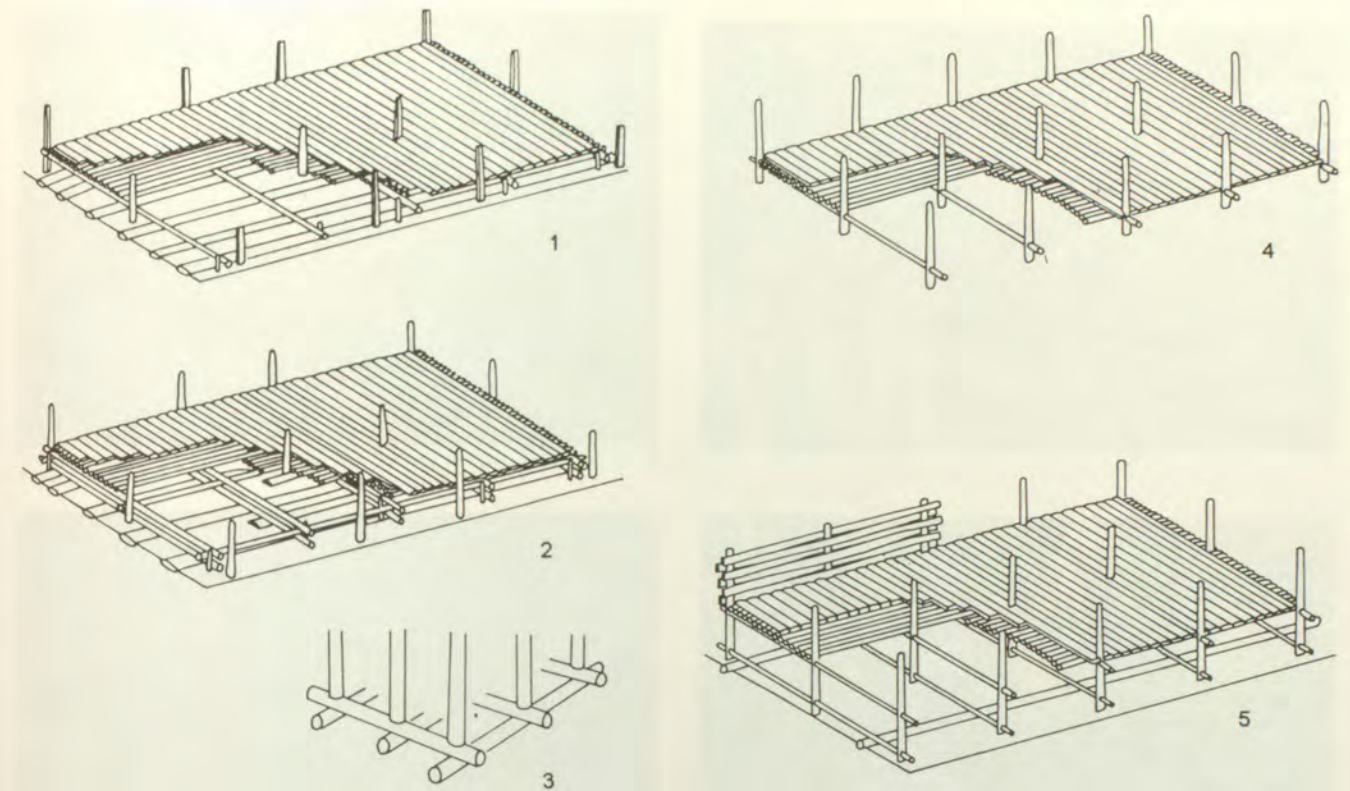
Bodenkonstruktionen in Thayngen-Weier [70]. 1 Schwellbalkenbau (Weier I); 2 Schwellbalkenbau (Weier II); 3 Detail; 4,5 Stelzbau (Weier III).
